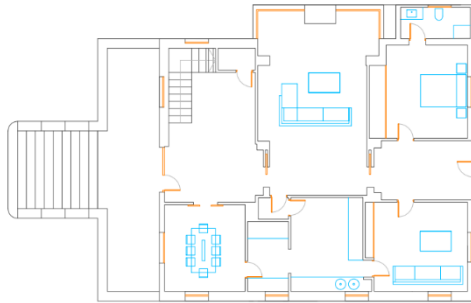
Plano de distribución Planta Baja. Fuente: CAD propio
